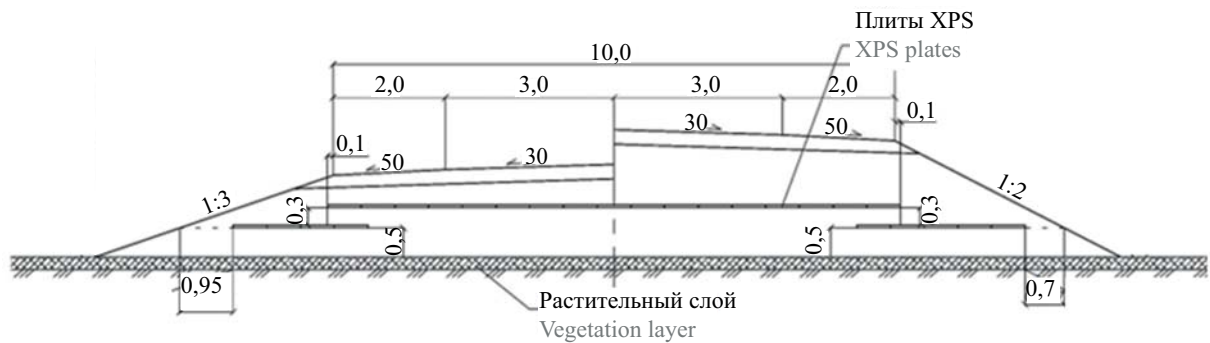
Расчетная схема насыпи для АД с теплоизолирующими плитами XPS на ММГ⁶
